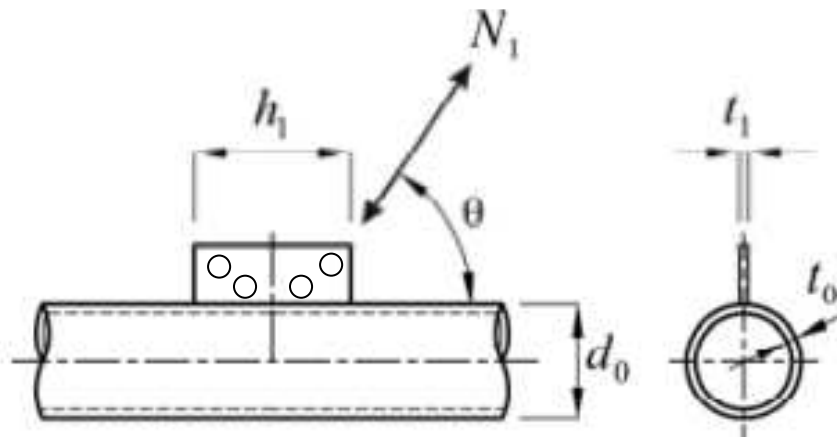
Chapa de ligação soldada ao banzo – Adaptado de ABNT NBR Tubos [5]
